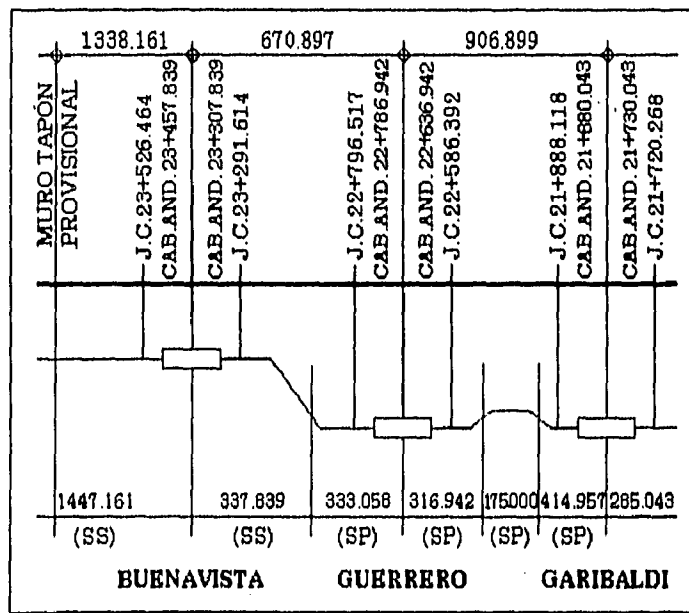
Perfil esquemático: juntas constructivas y cabeceras de estaciones.
